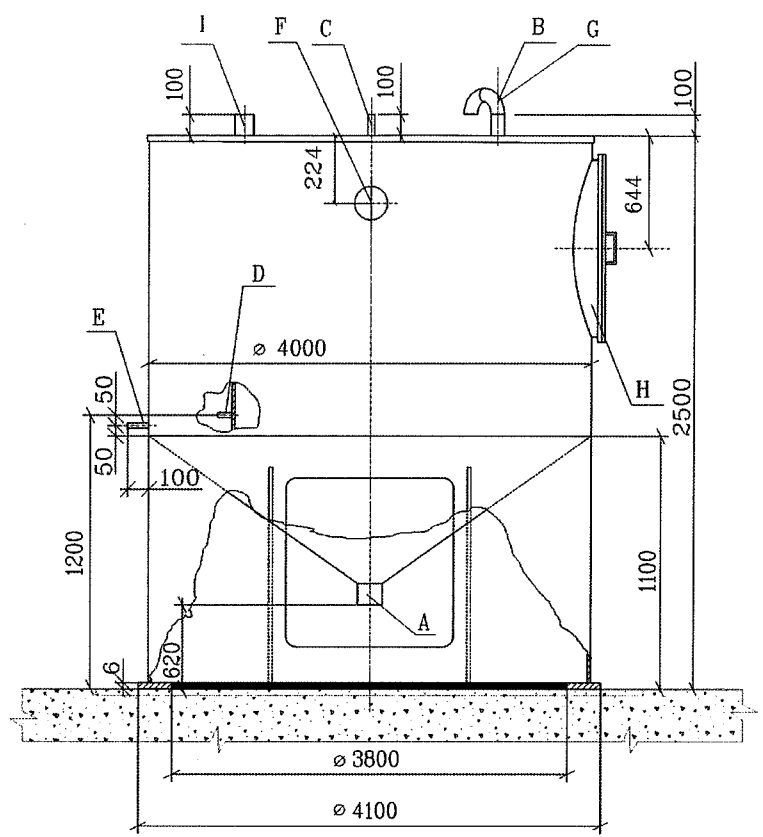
Габаритный чертеж контрольных баков приема стоков душевых вод
